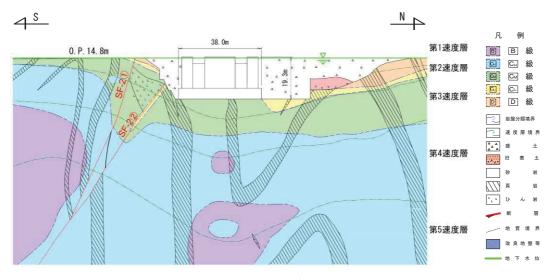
排気筒基礎 地震時荷重算出用地質断面図 (NS 断面)
